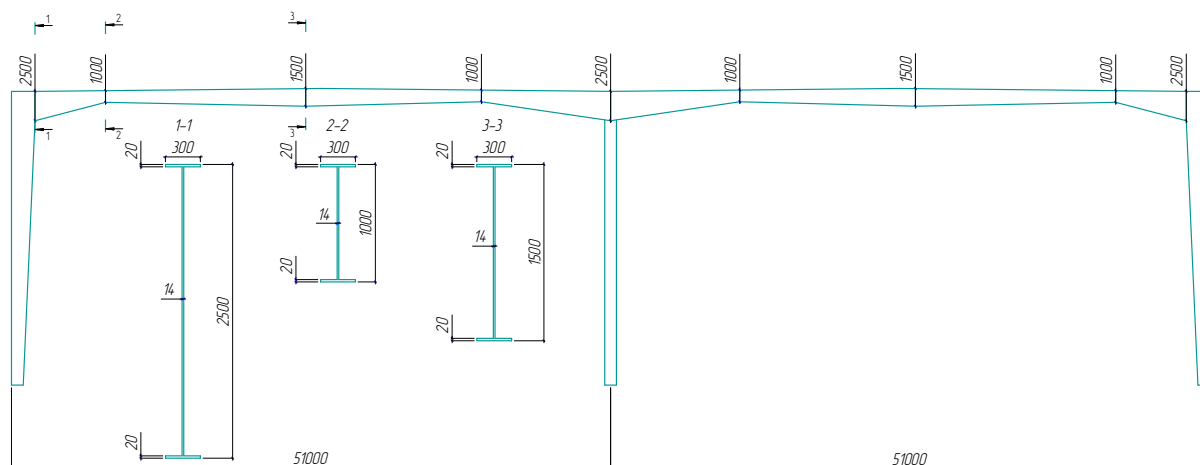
Расчетная схема двухпролетной рамы (вариант 3)
